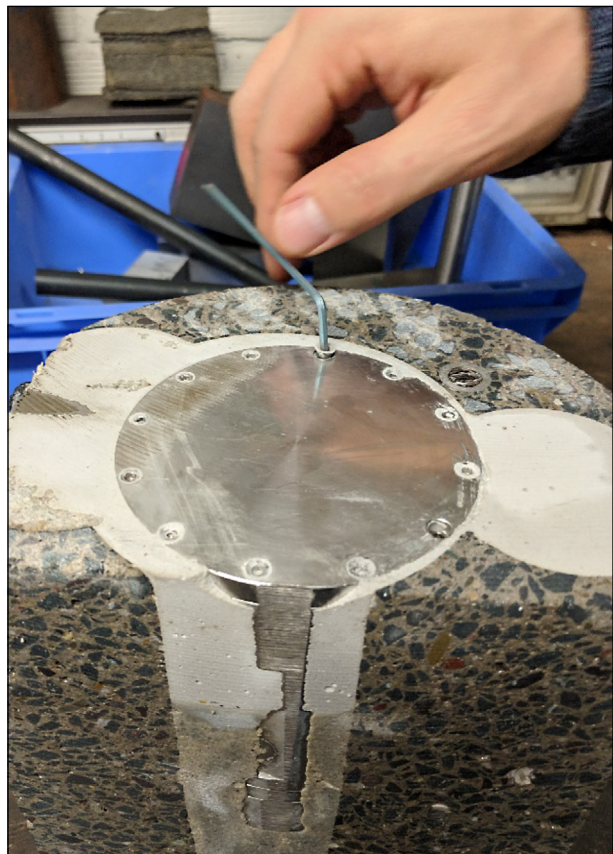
Entfernung der zwölf Schrauben zum Öffnen des Deckels
